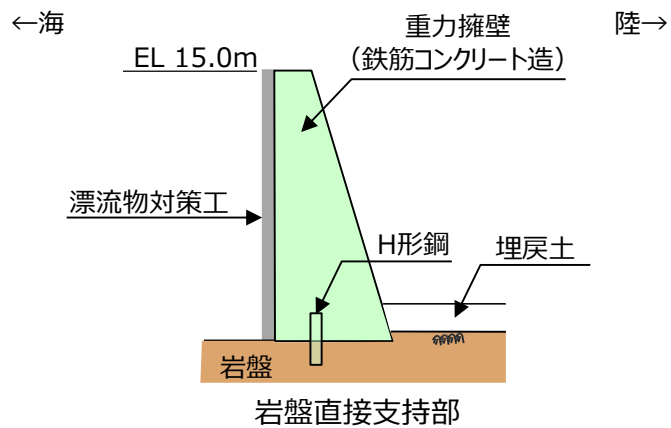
防波壁（波返重力擁壁）の構造概要図（断面図）
